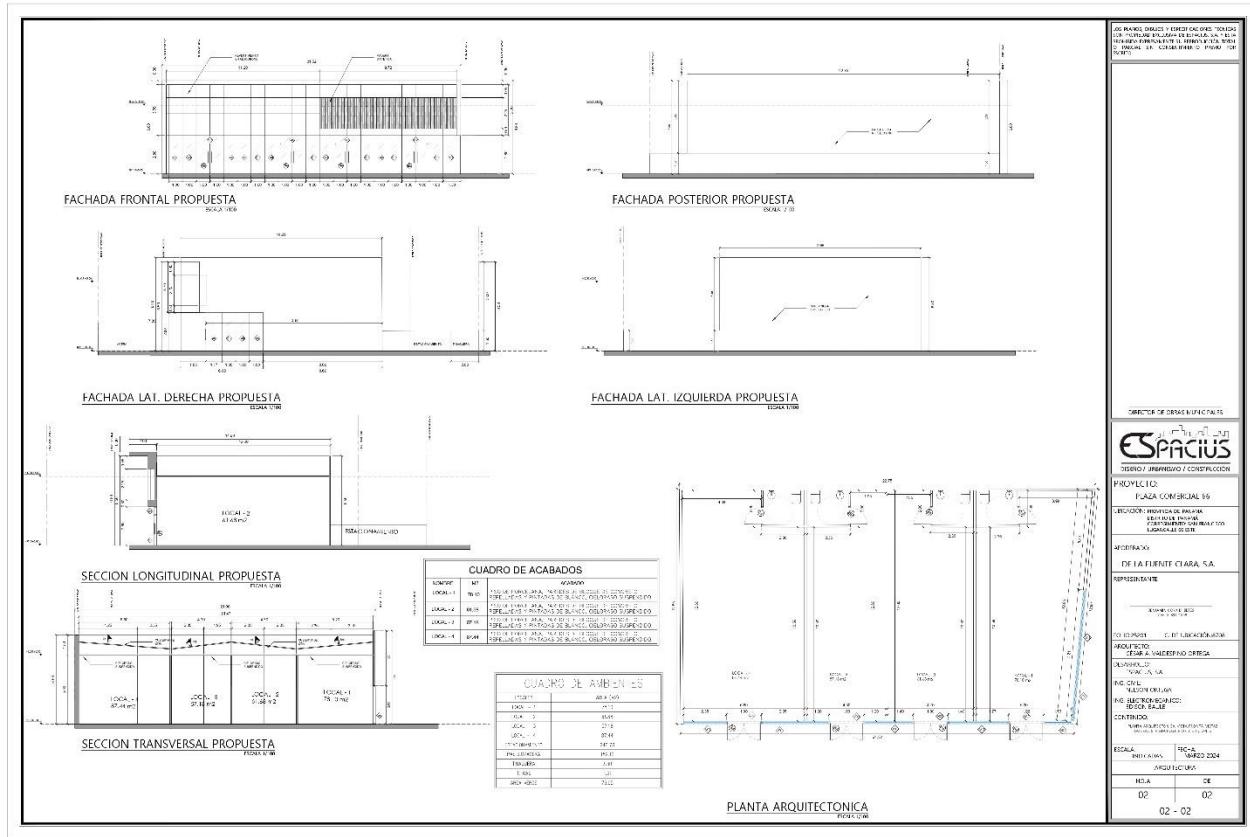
,5. Planos del Proyecto. Fachada, secciones transversales, longitudinales.
